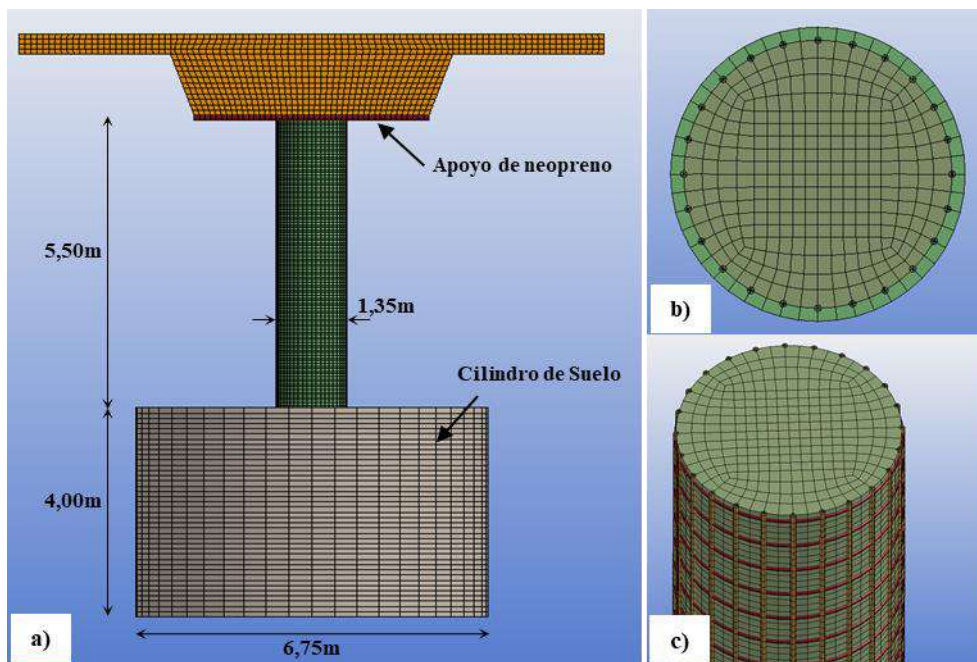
a) Modelo de elementos finitos del puente de calle Boedo, apoyo en estribo. b) Sección transversal de la columna. c) Detalle de armadura de refuerzo de la columna.
